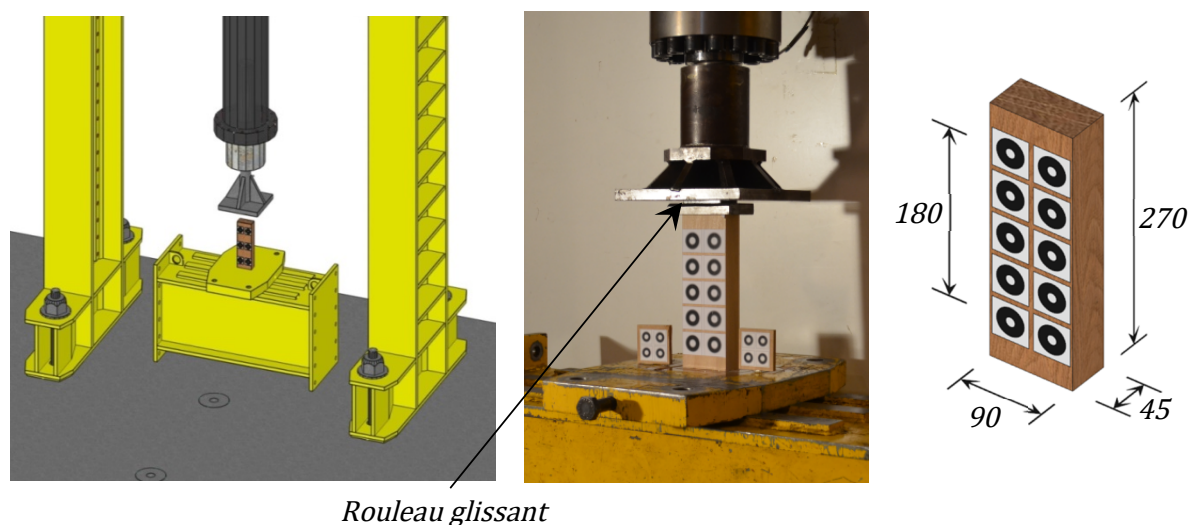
Montage de compression axiale sur la dalle d'essais.
